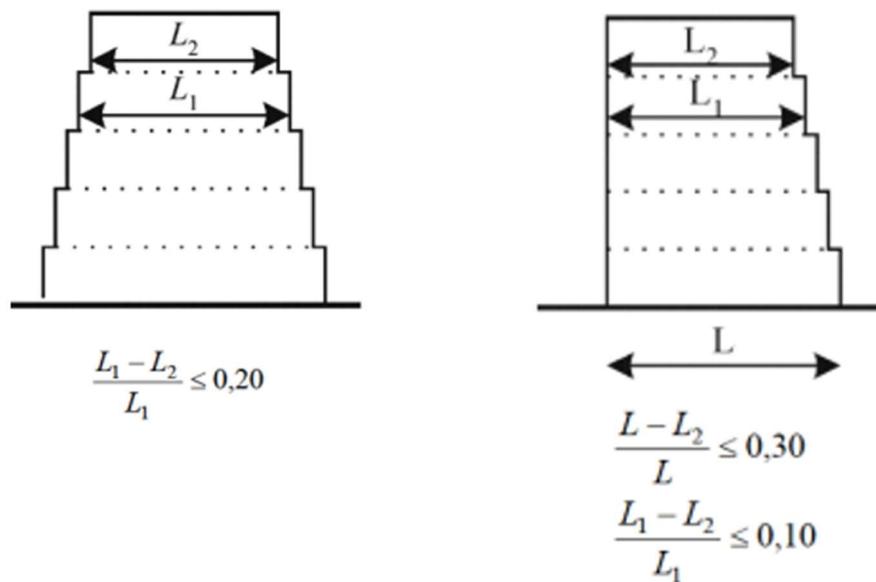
Irregolarità in elevazione (restringimento della sezione orizzontale)
